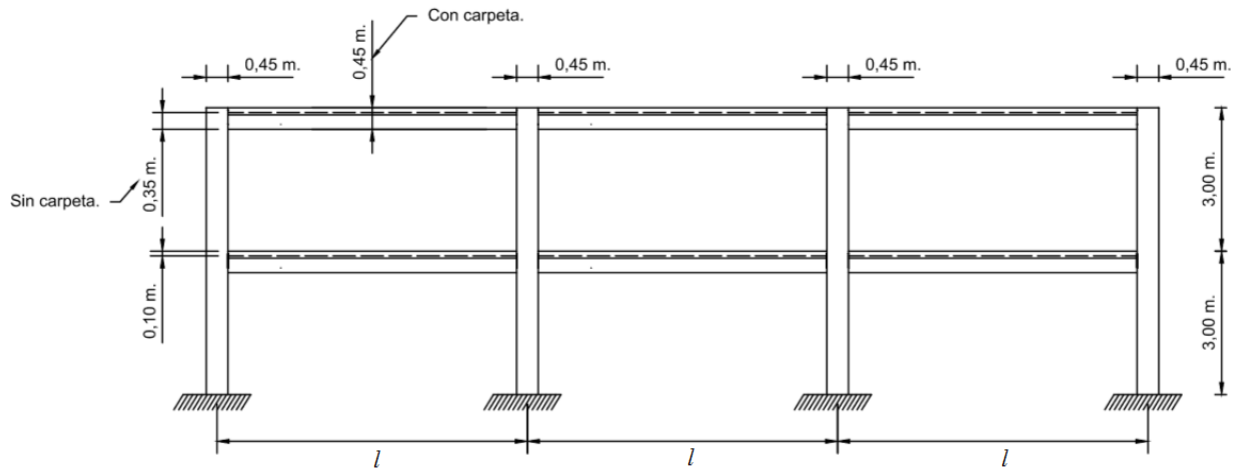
Pórtico conformado con Losas TT de sección constante más carpeta y muros.
